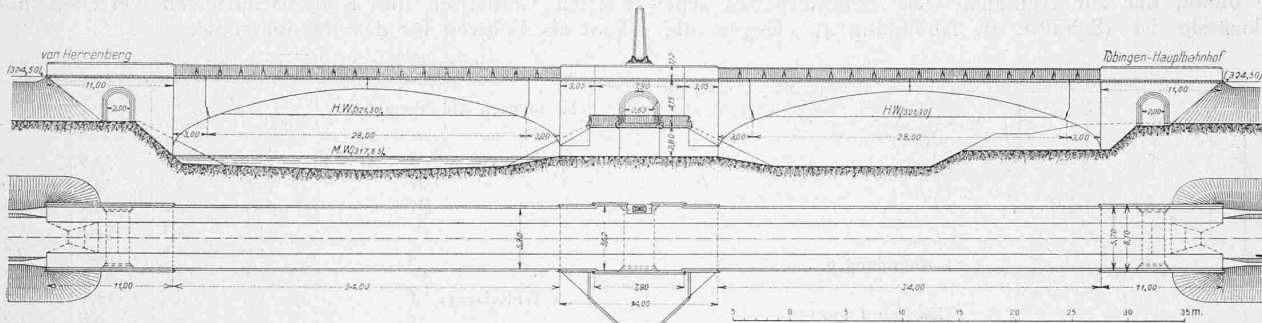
Grundriss und Ansicht von der Oberwasserseite. — Masstab 1 : 600.
